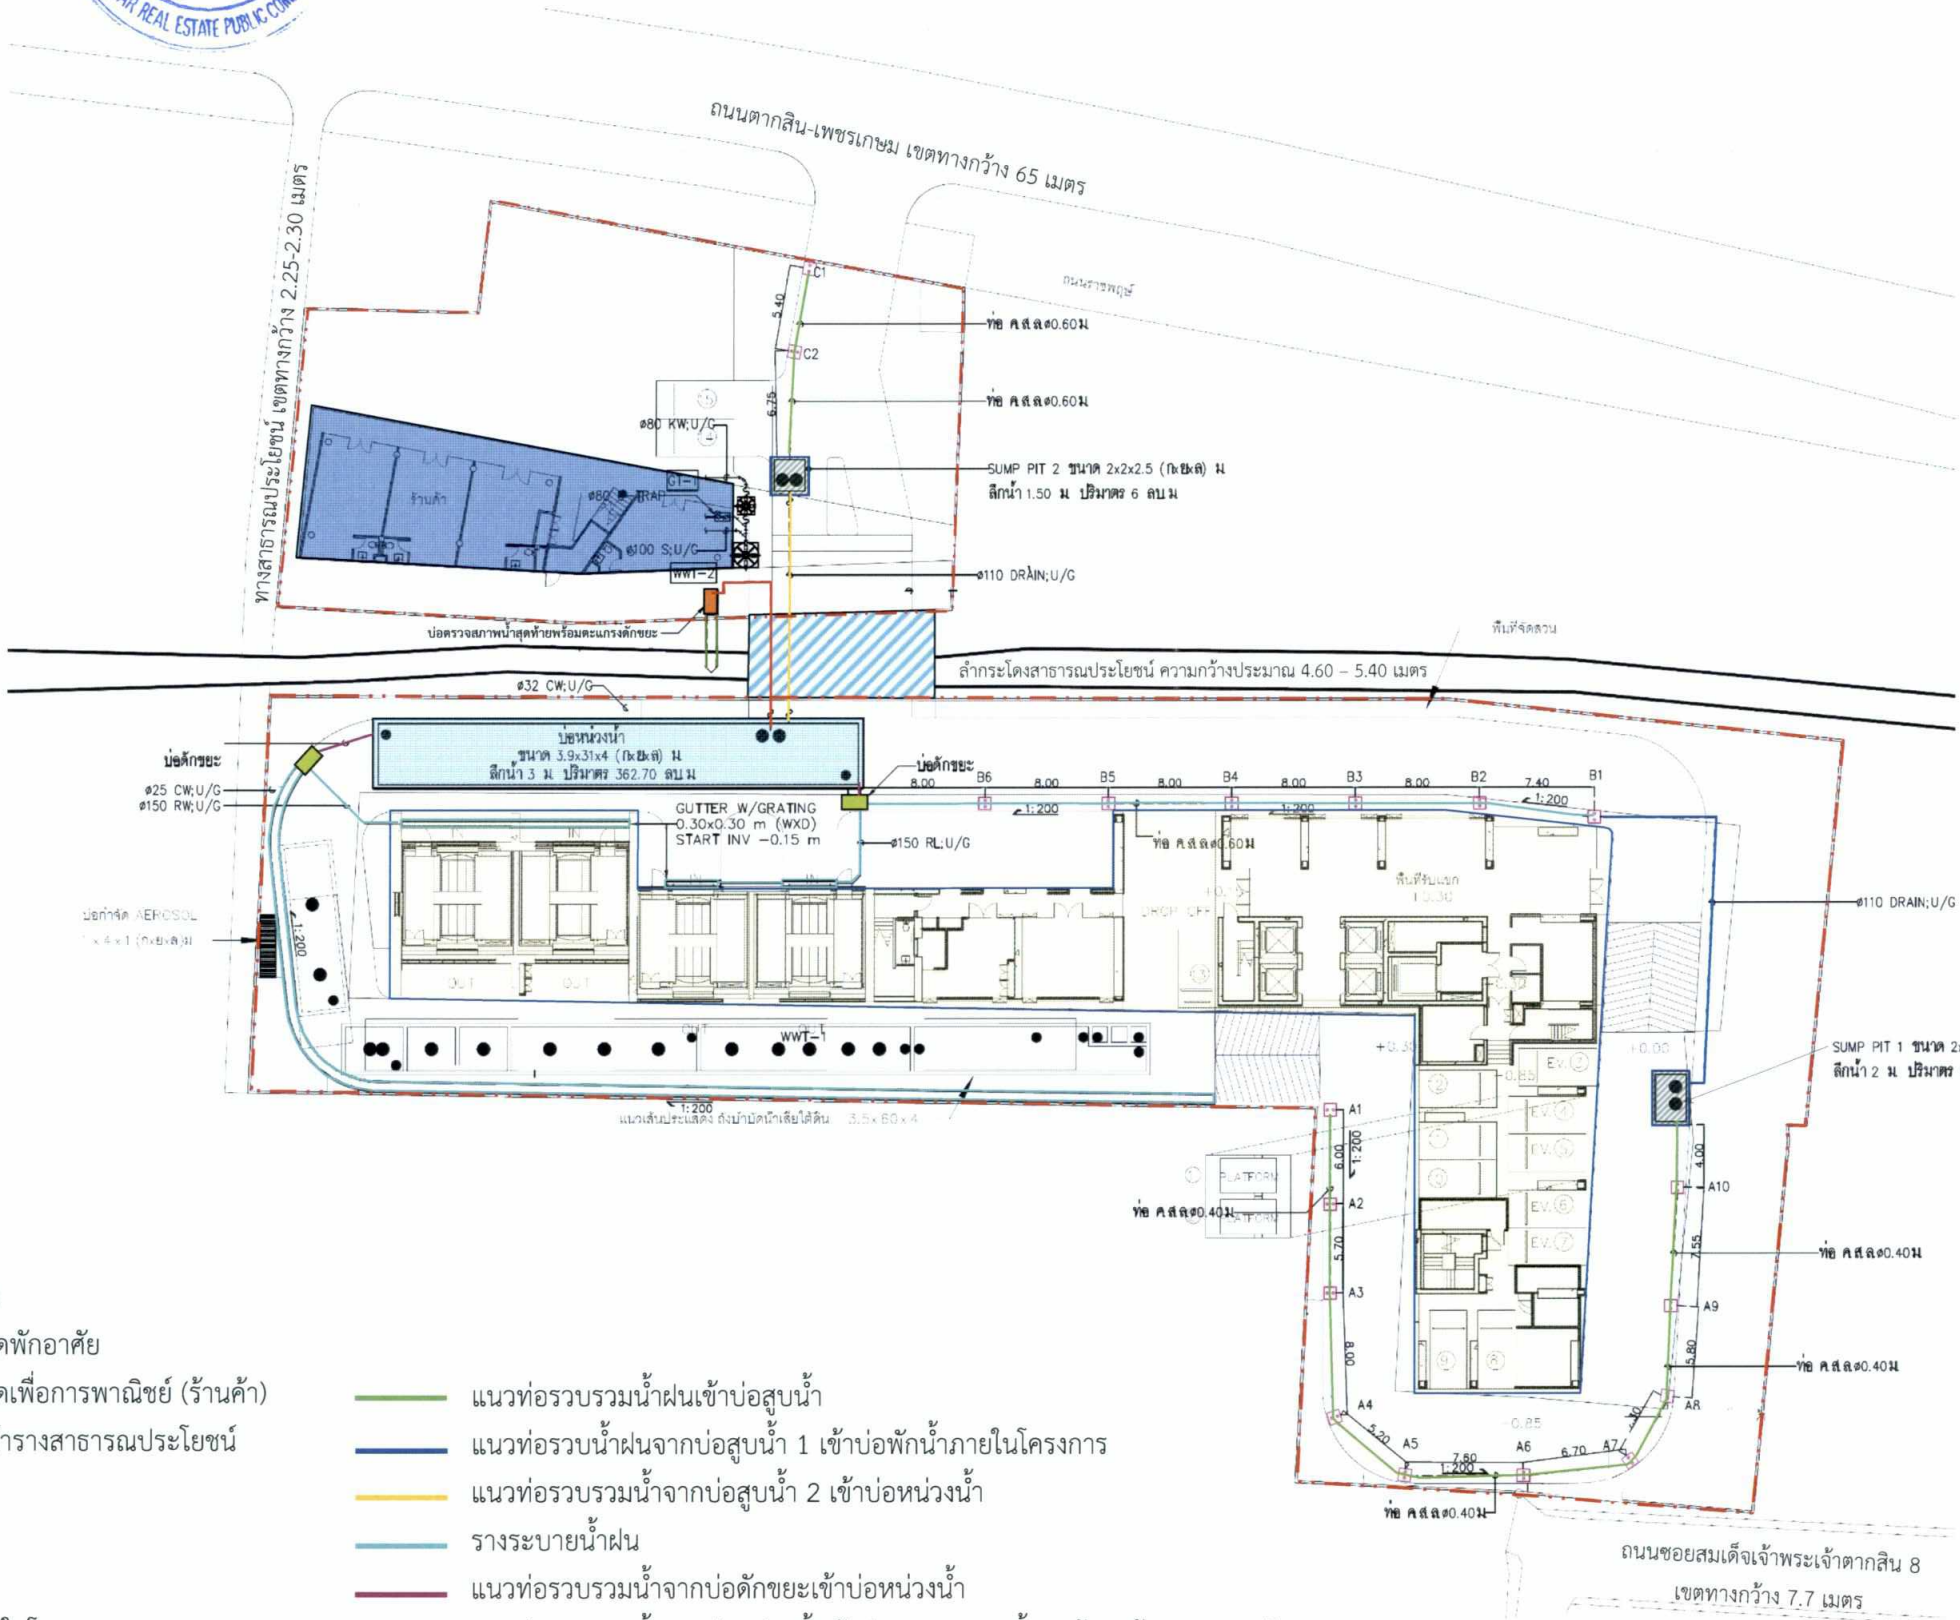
ผังระบายน้ำเสียของโครงการ
